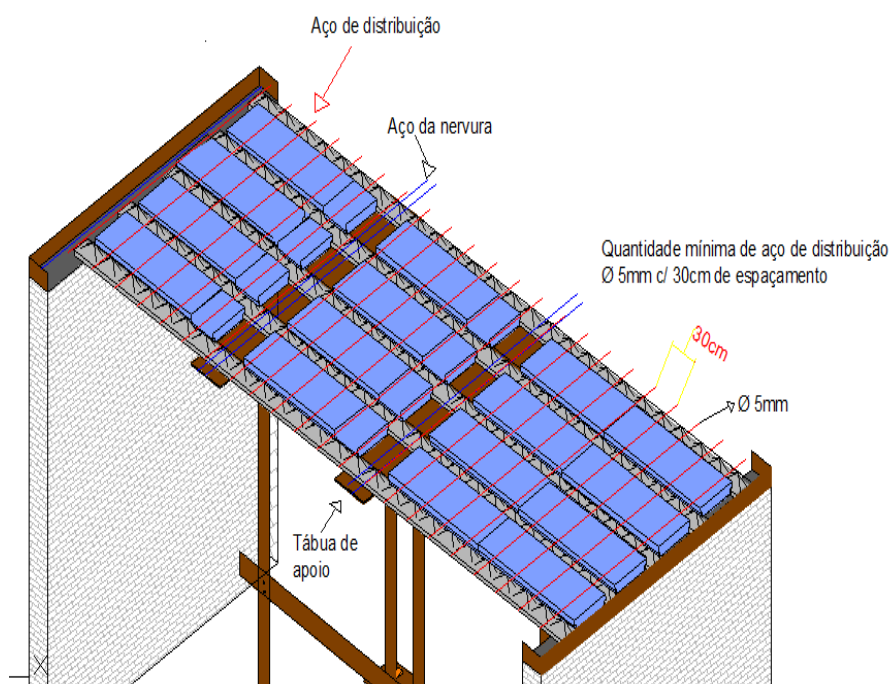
Colocação de armadura de distribuição e elementos de enchimento.
